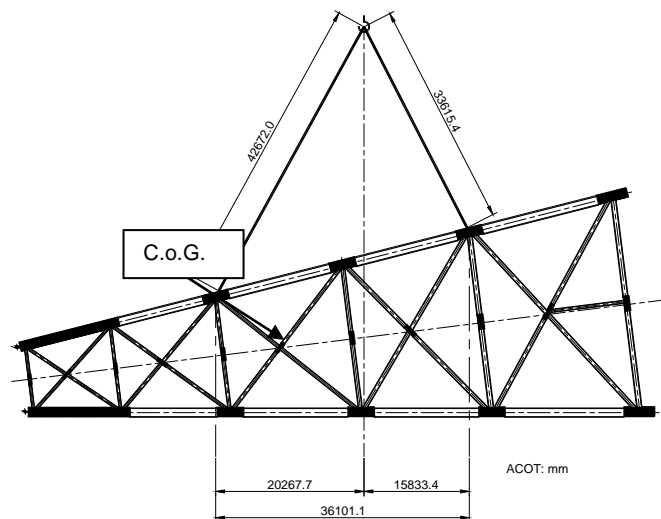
Ejemplo de un arreglo de cables de izaje para un trípode.
